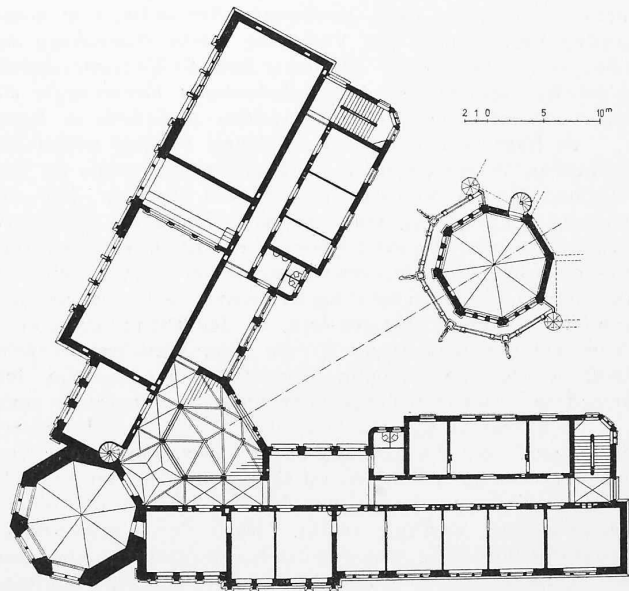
Grundriss vom II. Obergeschoss.
